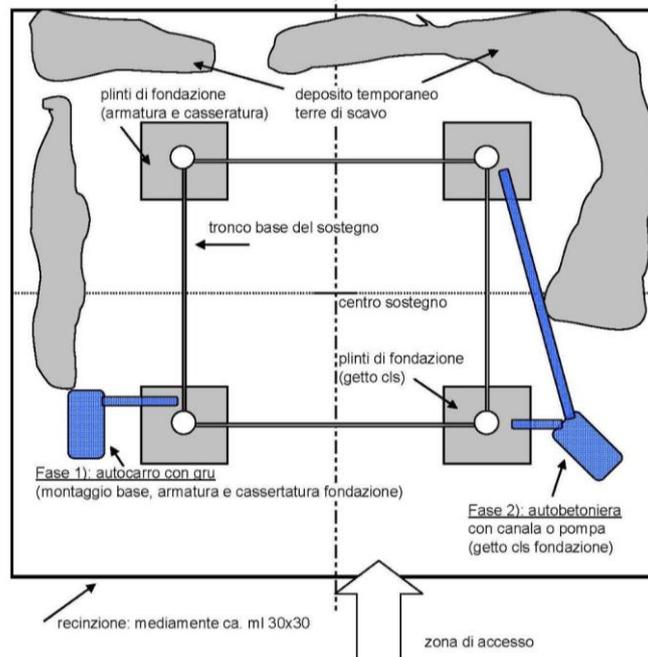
Planimetria dell'area di microcantiere (linea 380 kV) - fase di lavoro: getto e basi
